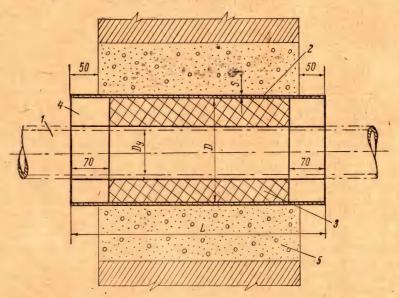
Футляр для прохода газопроводов через фундамент и стены:
